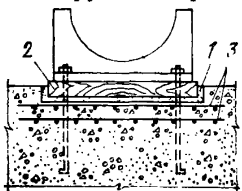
Предохранение бетона фундаментов под рамой кармана от разрушения
